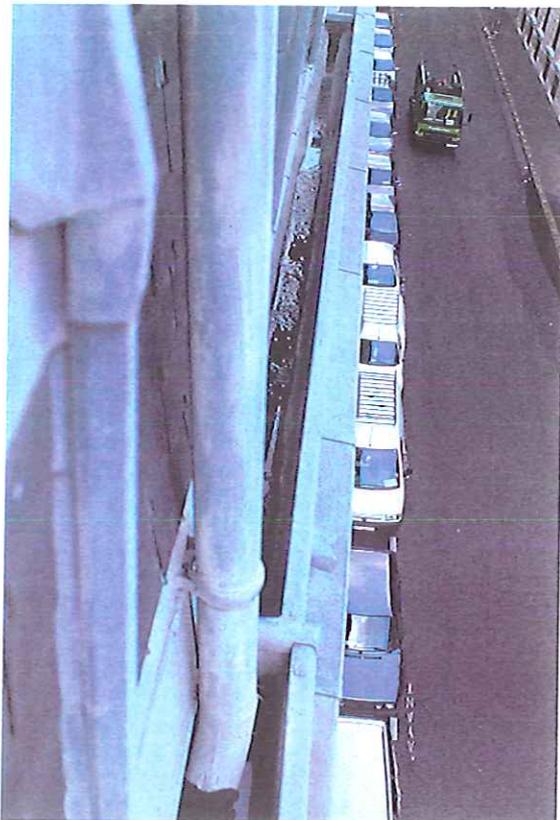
à 51 – vues de détails de la façade, côté rue de Valois. Etat sanitaire et disparité de la typologie générale : soubassement en ciment, salissures, jeux de fissures, desquamation partielle de l'enduit plâtre, grilles de ventilation anachroniques (1), quelques désordres structurels apparaissant à travers «la peau» de l'enduit : fissures, décollement de l'enduit (2).
